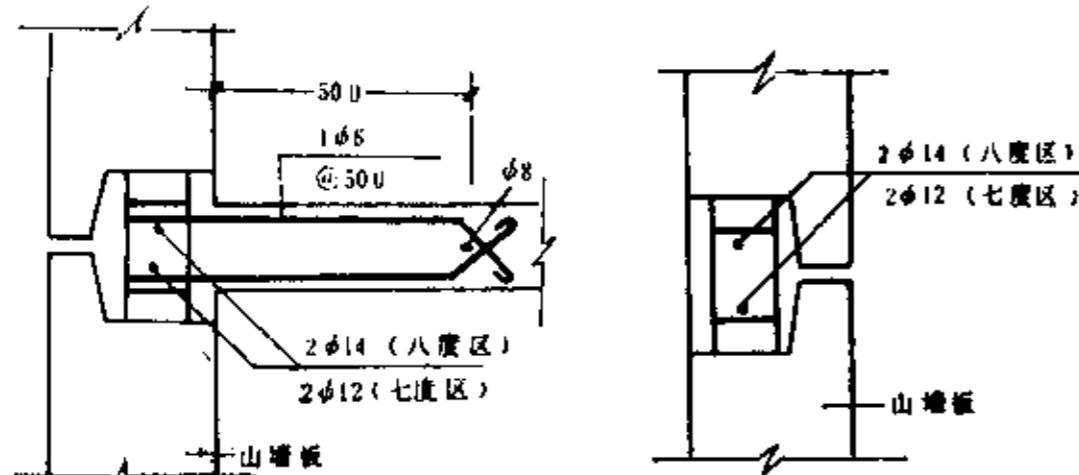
内外墙联结构造图 图 5.0.4-4 外墙板联结构造图
